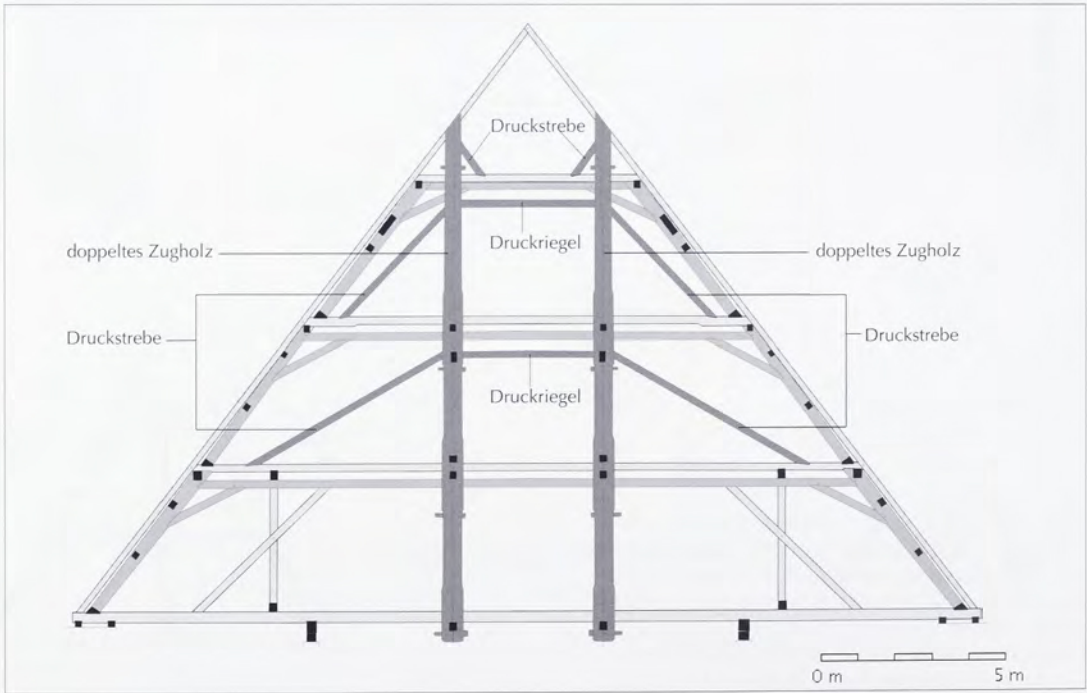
Zweifaches Hängewerk (dunkelgrau) mit zweifach abgestrebt Quer-bünden (mittelgrau). Obermarchtal, Klosterkirche, Dachwerk über dem Chor, 1686 (a).
